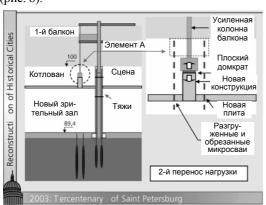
Методы укрепления фундаментов: вторая схема перераспределения нагрузки
